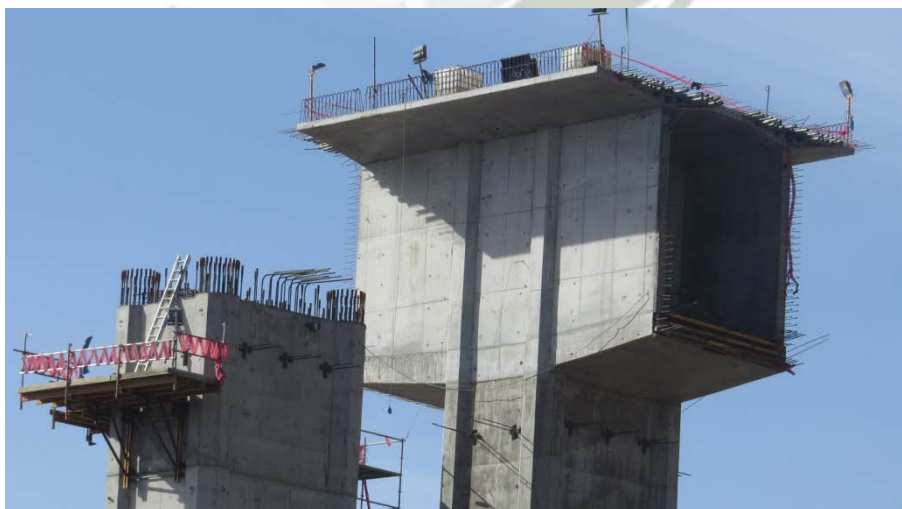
Fuente Arch. Fotográfico Puente Chilina – P 03: Dovela “0” Ejecutada
